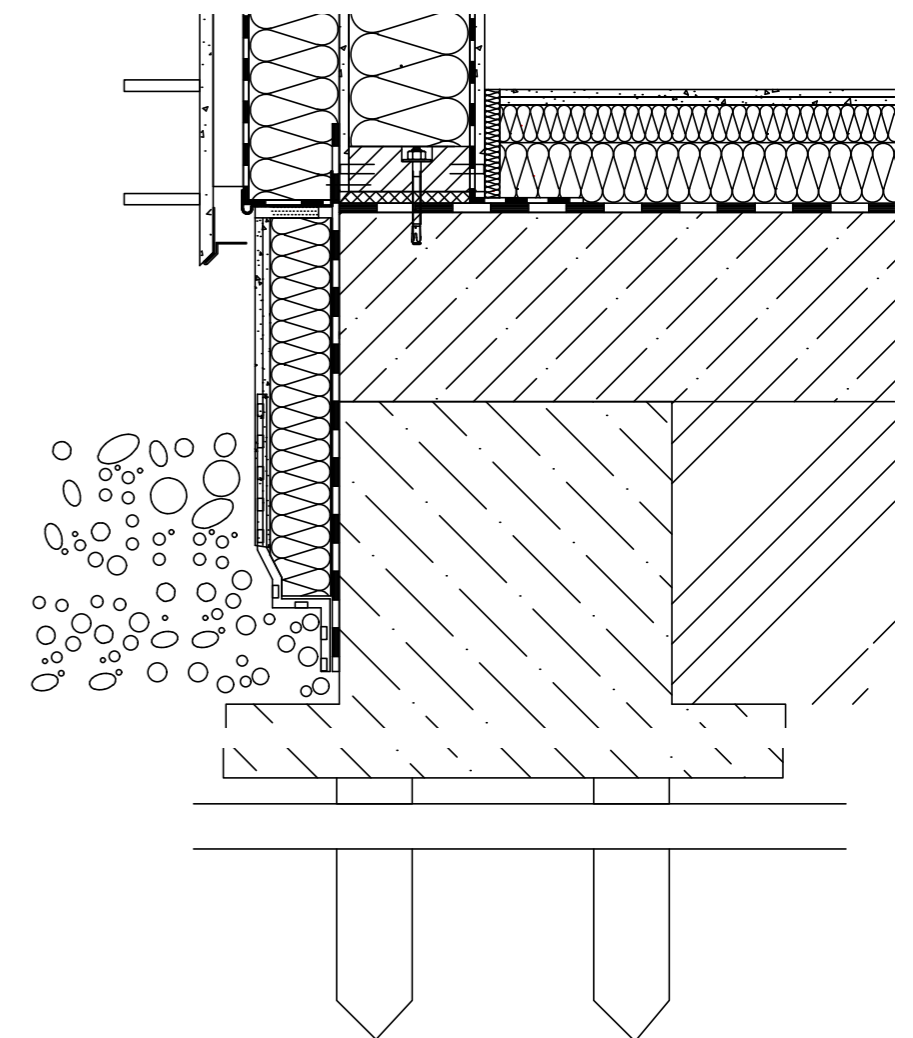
DETAIL NAPOJENÍ STROPNÍ KONSTRUKCE | 1:10
